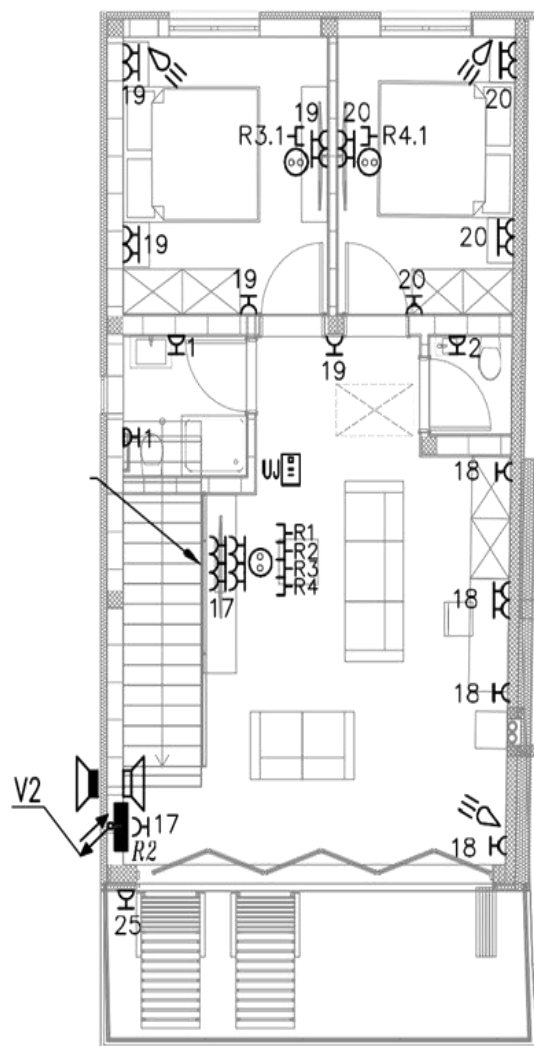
Elektroinstalacija snage i slabe struje - prizemlje
